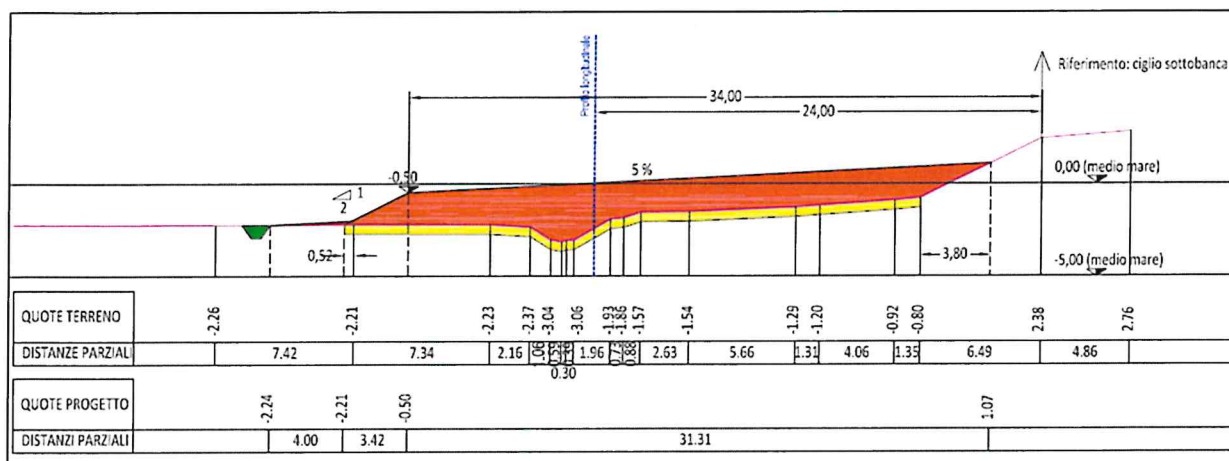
Località Pioppe - Sezione trasversale nuovo rilevato in corrispondenza del fontanazzo
